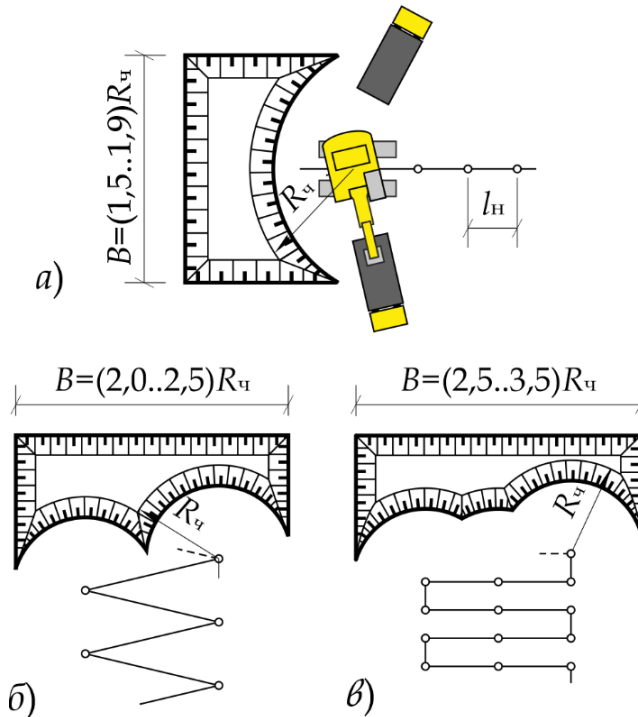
Розробка котловану екскаватором зворотна лопата: а – лобова західка по прямій; б – лобова західка по зигзагу; в – лобова розширена західка
